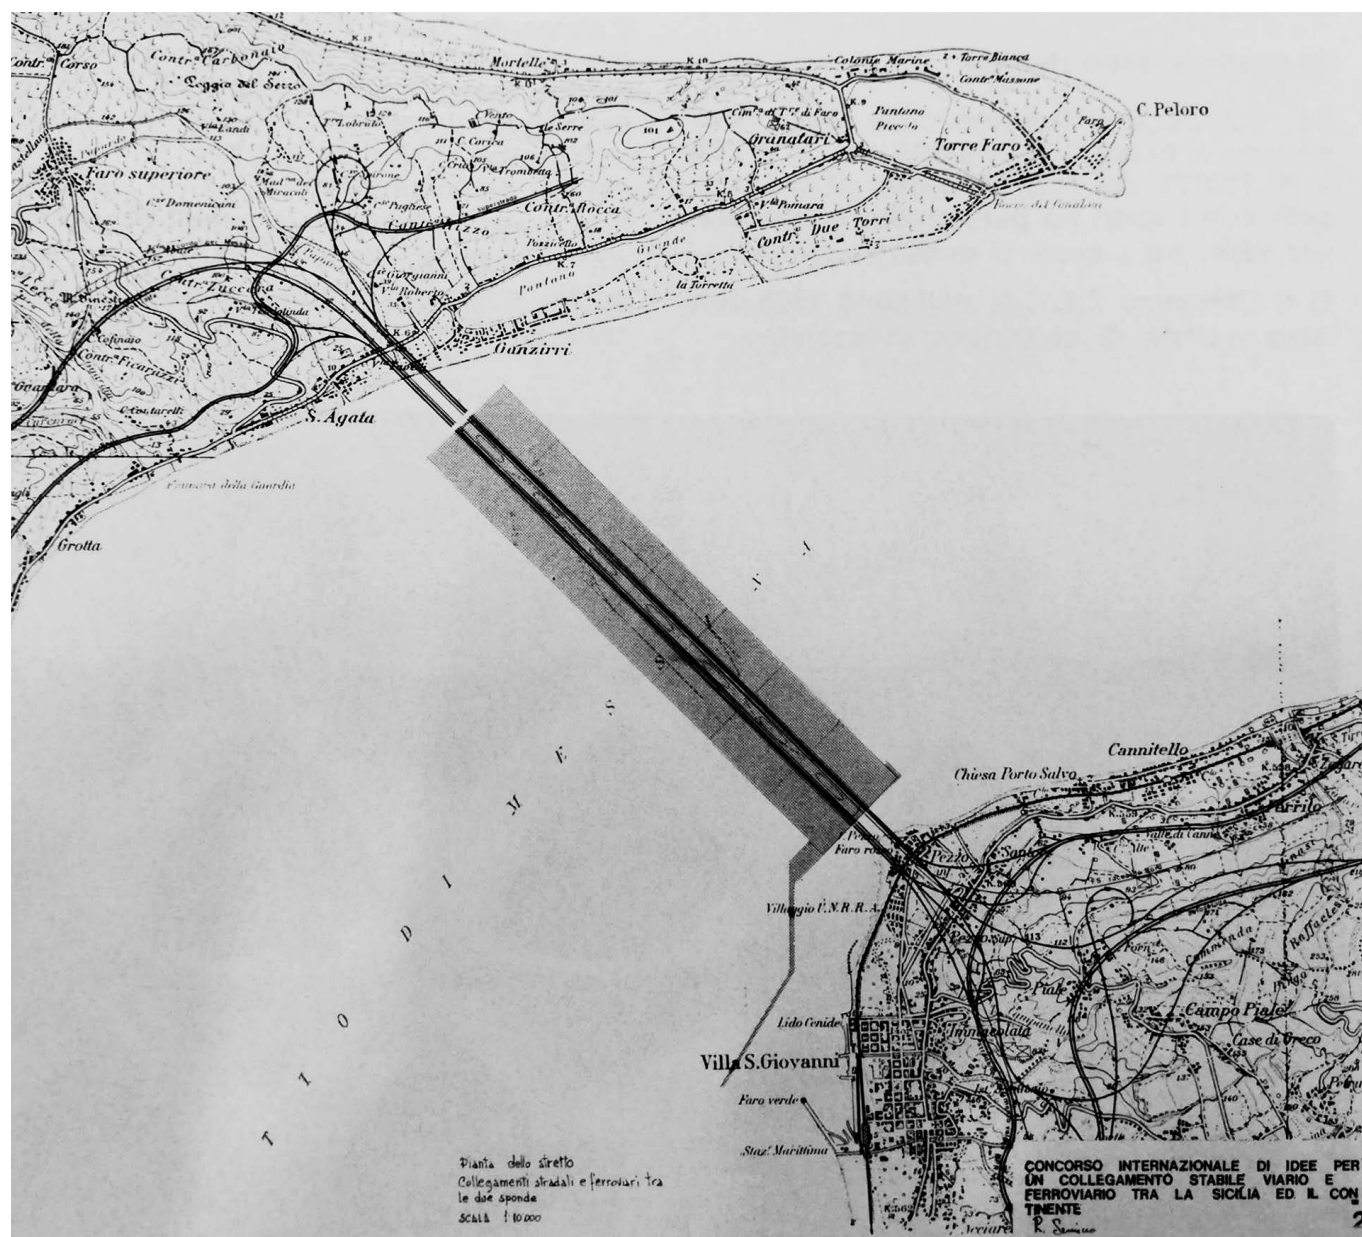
R. Semino, planimetria della piastra galleggiante sullo Stretto di Messina, 1969 (per gentile concessione dell'arch. Rinaldo Semino).
